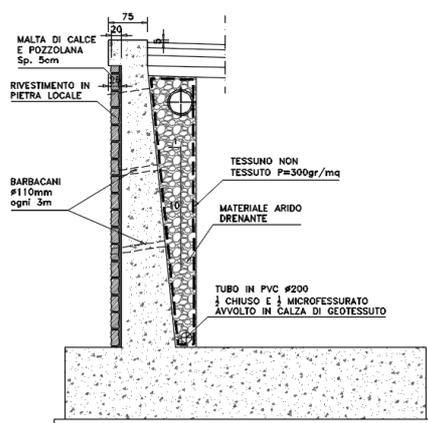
Sezione tipo muro di sostegno su fondazione diretta
